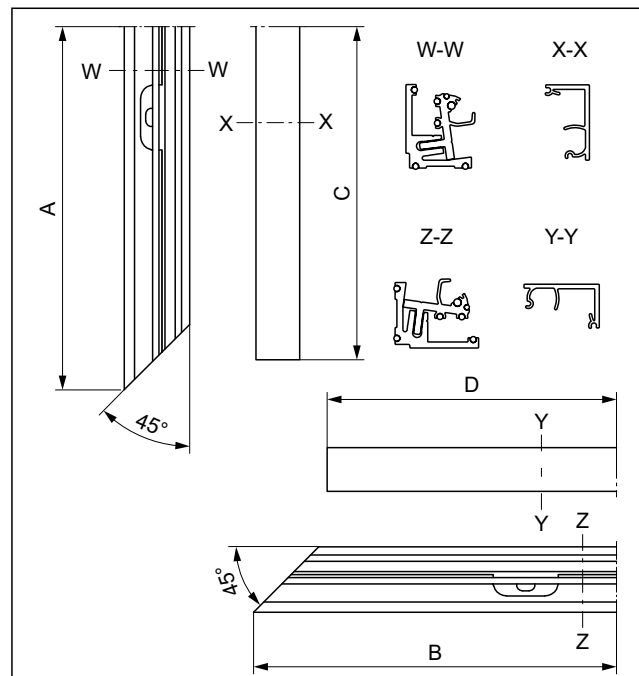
Eckstoß für Außenecke, bauseitiger Profilschnitt
